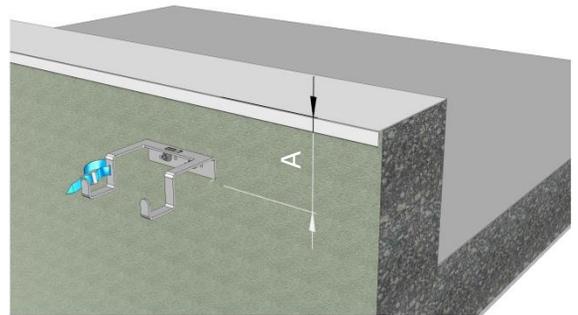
LUX-top® LS III montiert an Stahlbetonfassade
